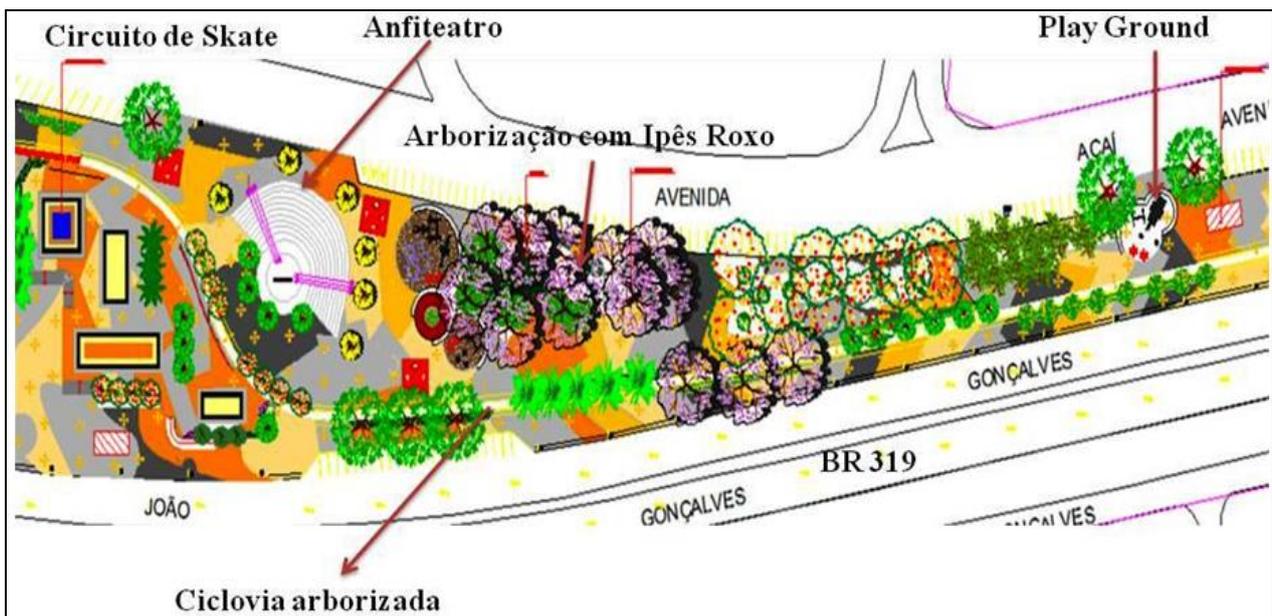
Planta de layout da 2ª parte do Calçadão da SUFRAMA (trecho 02).
